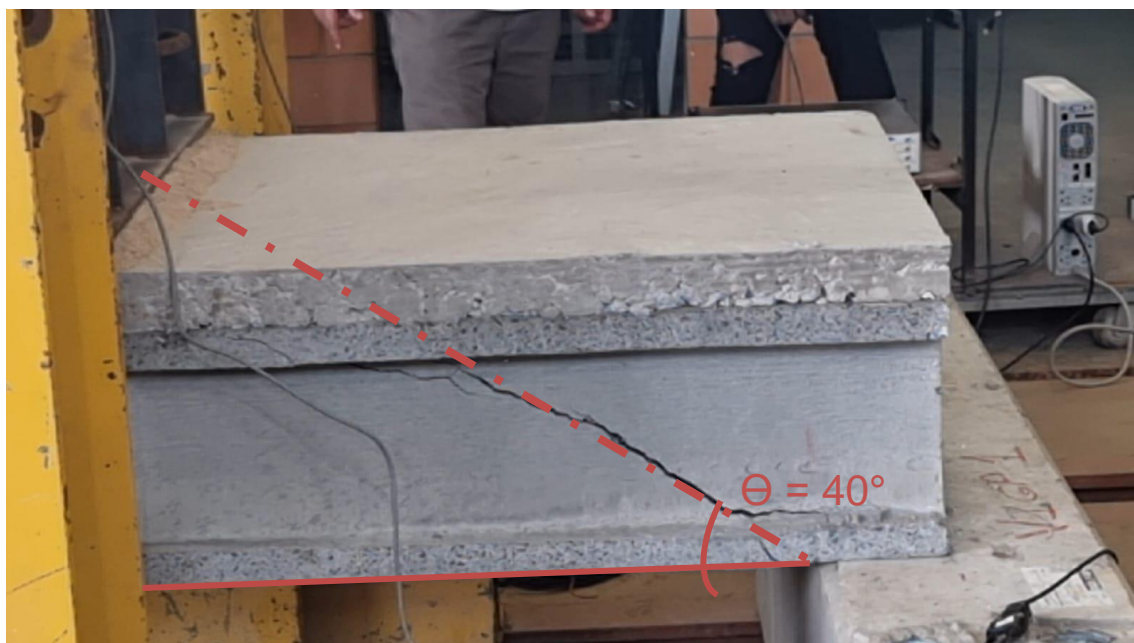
Fissura de ruptura – lado direito -laje com capa
